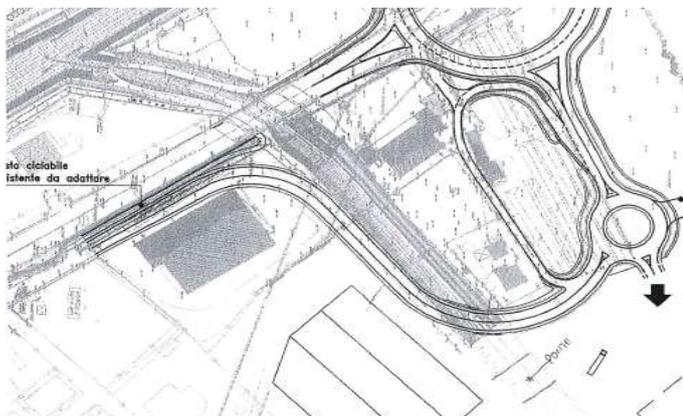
progetto Preliminare prot. 215529 del 05/12/2007
